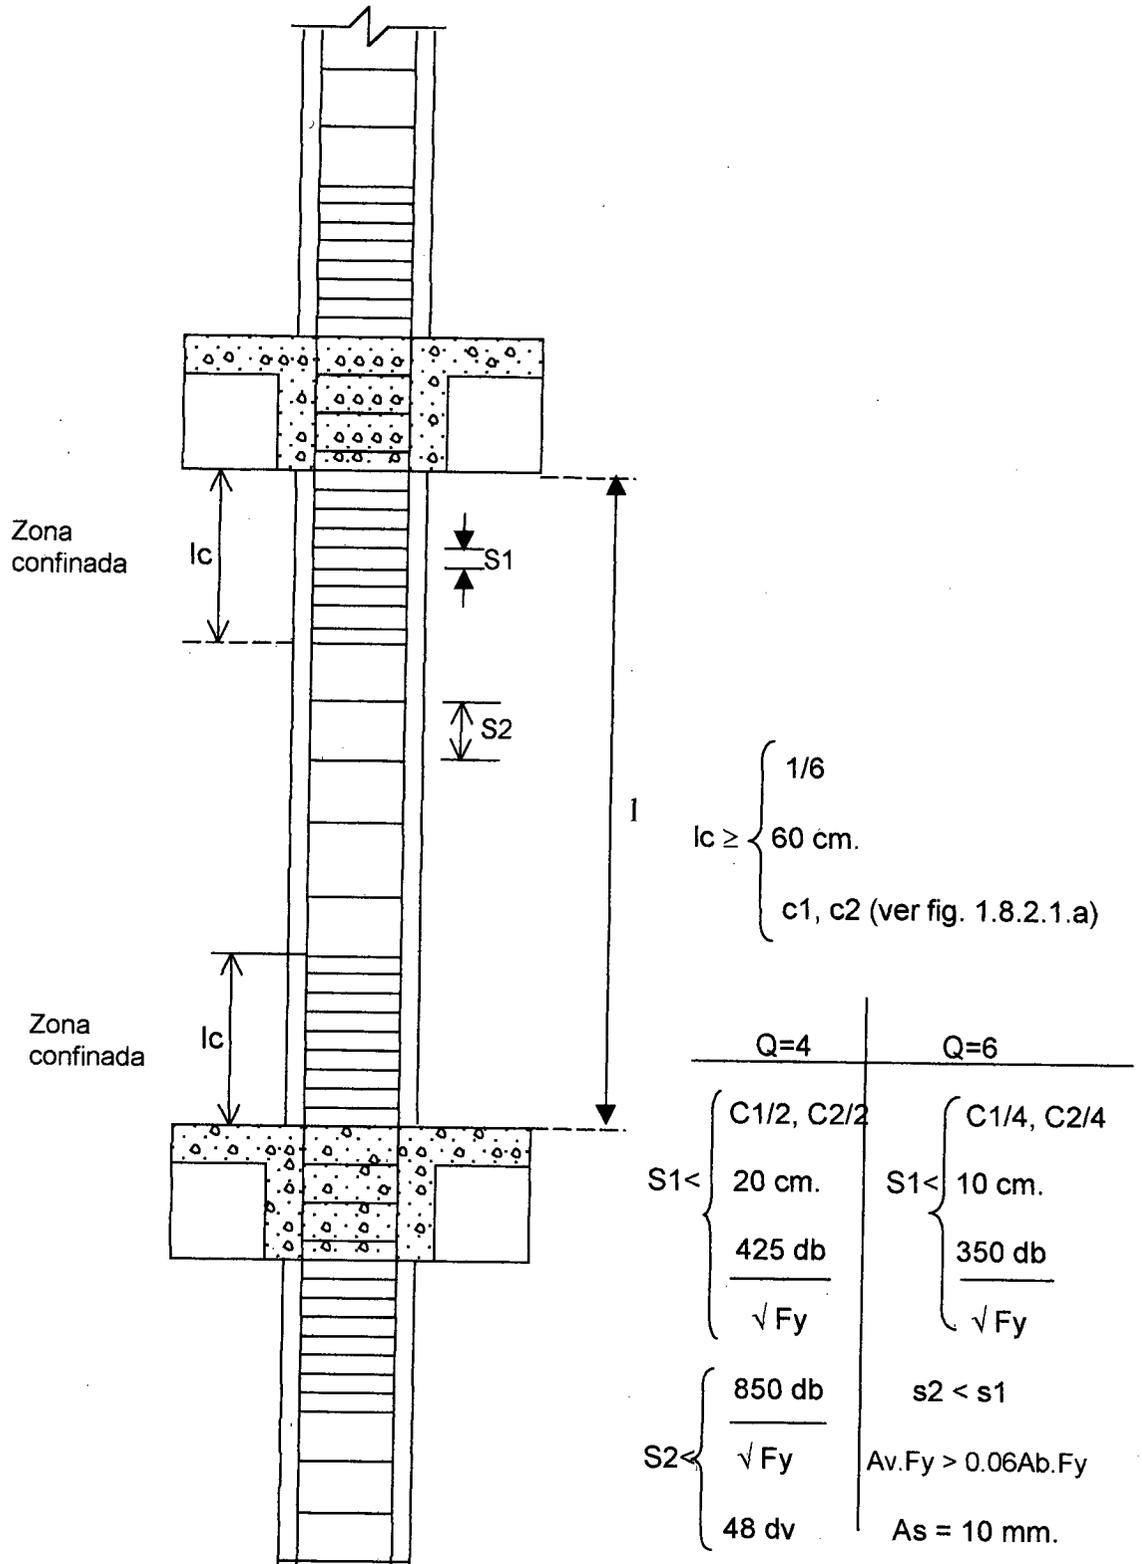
b Requisitos para refuerzo transversal en columnas de concreto.
